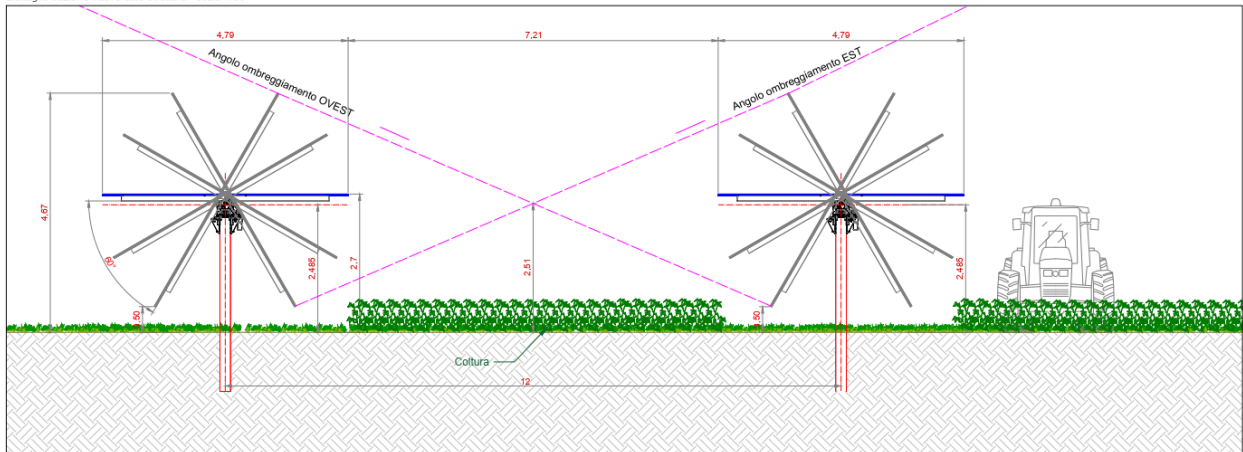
Sezione trasversale tipologica struttura Tracker
